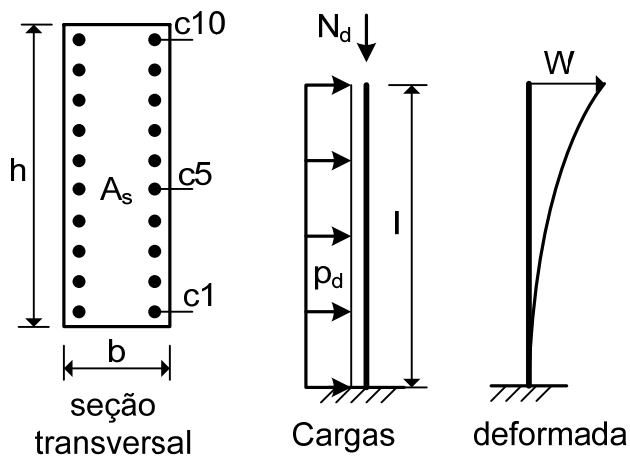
Seção transversal e carregamento das paredes estruturais
